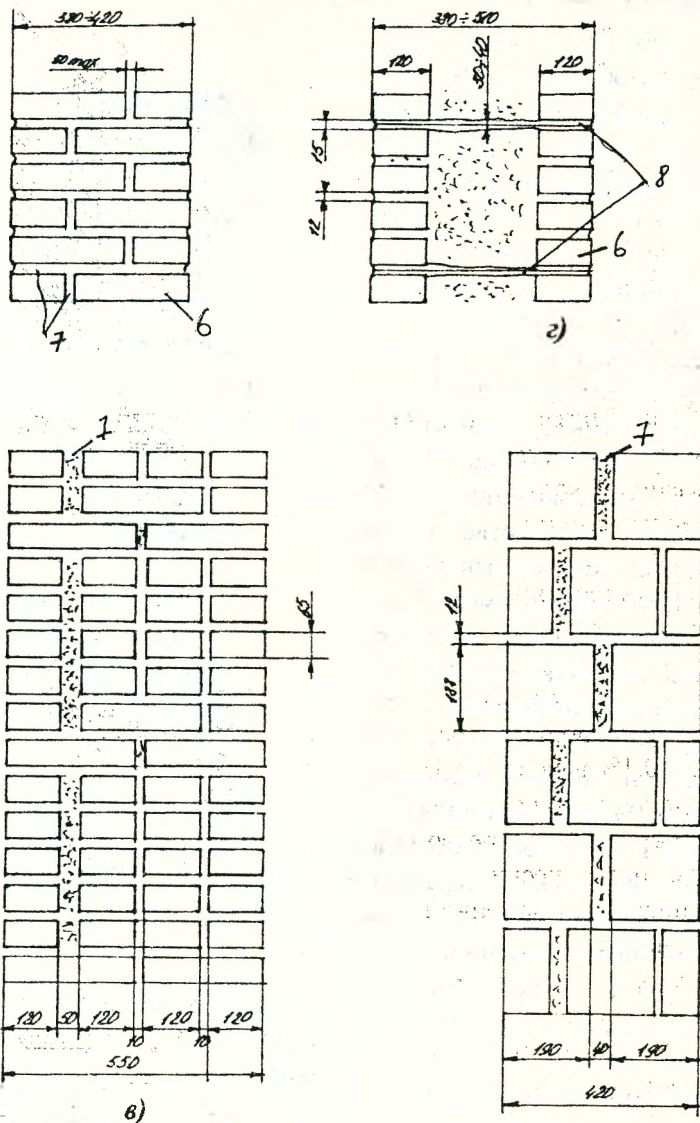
в, г. Кладка стен облегченных конструкций.
